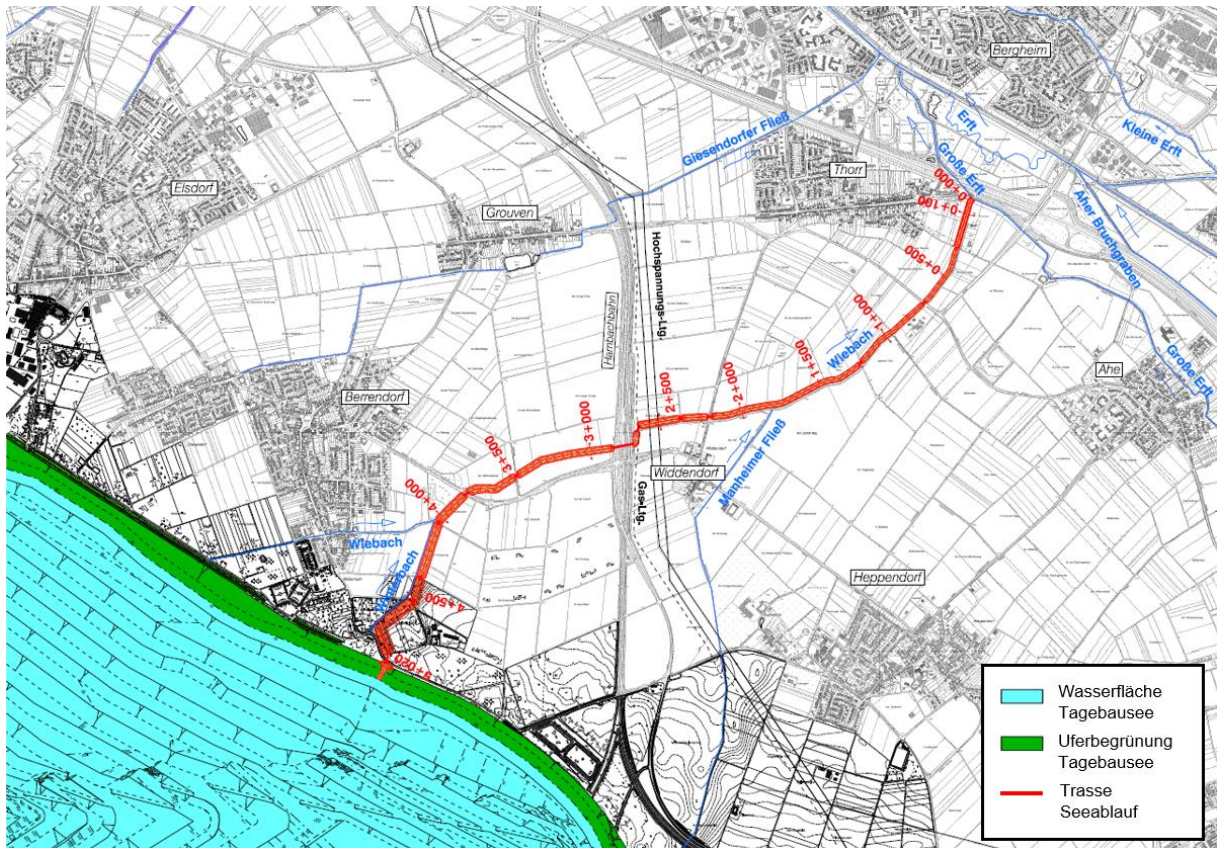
Detaildarstellung der Vorzugstrasse Wiebach für den Ablauf des Tagebausees Hambach zur Erft.
